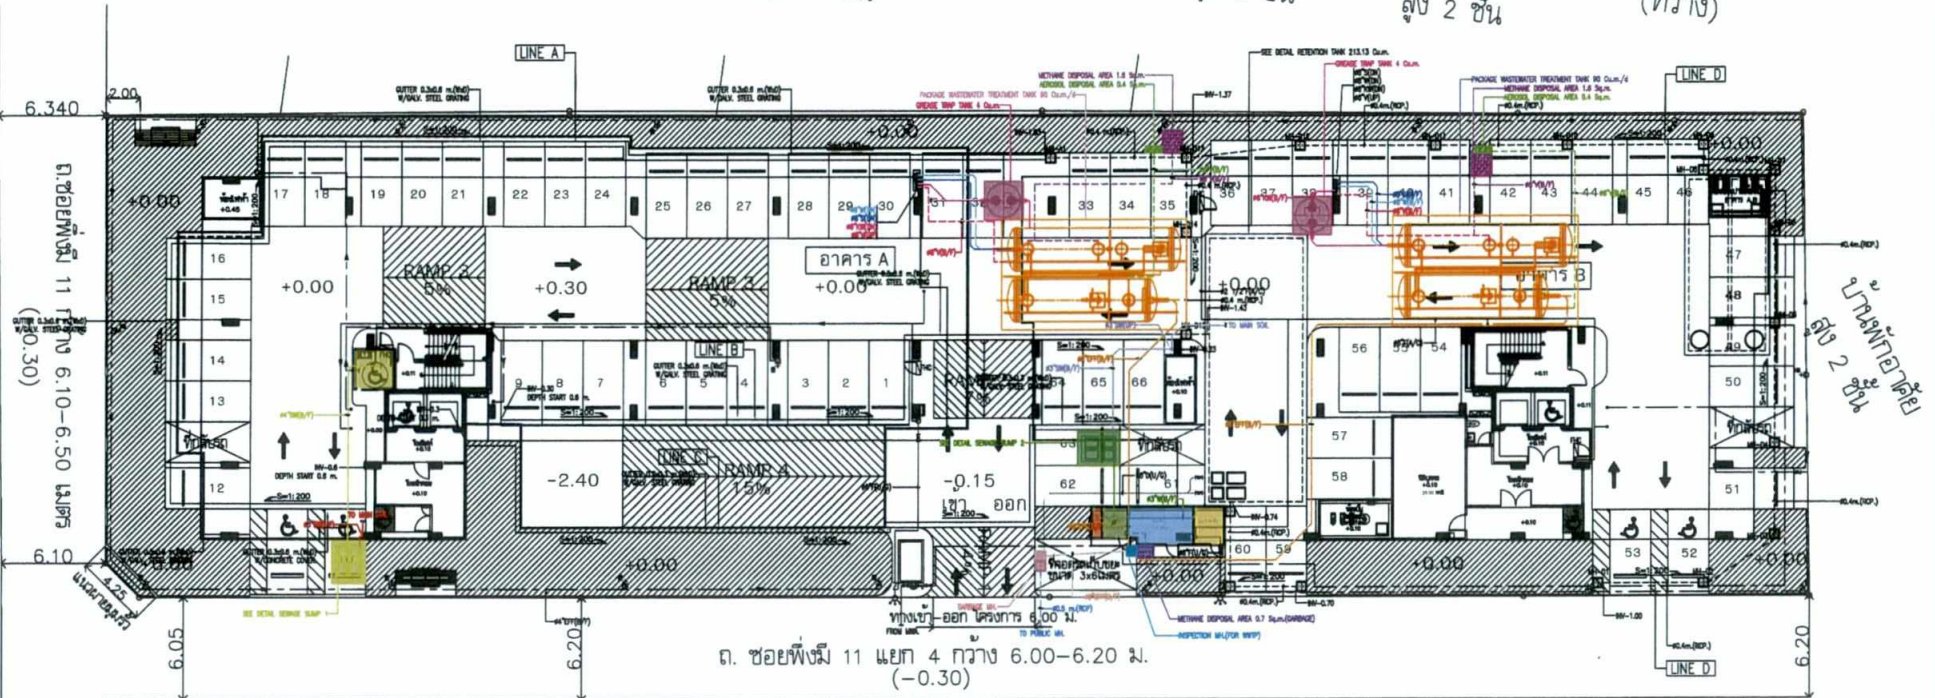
ผังแสดงระบบประปาของโครงการ
